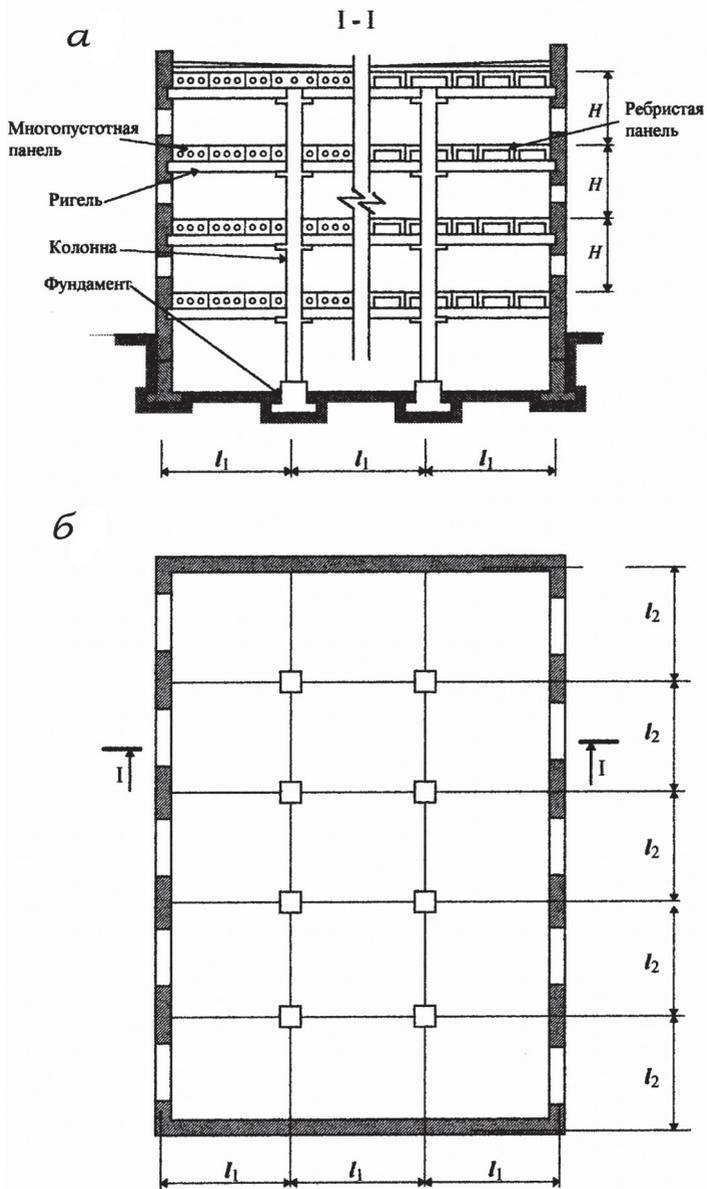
Поперечный разрез (а) и план типового этажа (б) здания
